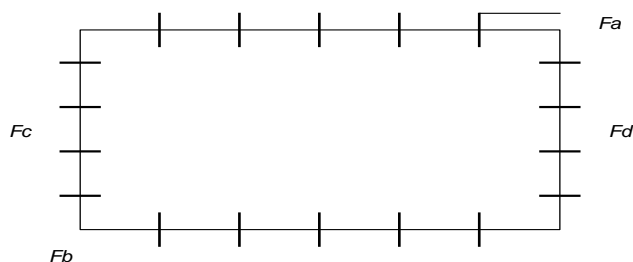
Армирование плиты на опоре (нижняя арматура)
